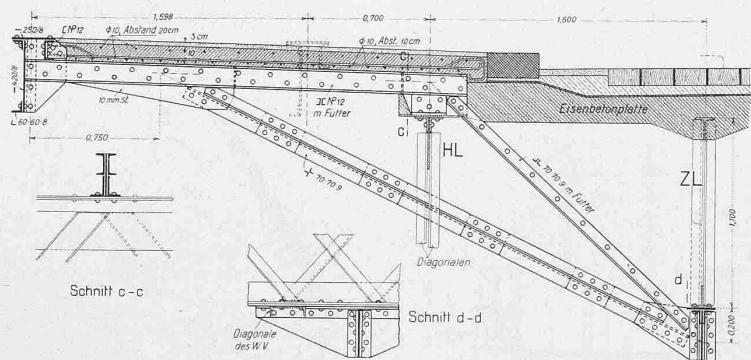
Eiserne Konsole der Ausrundungskonstruktion.
